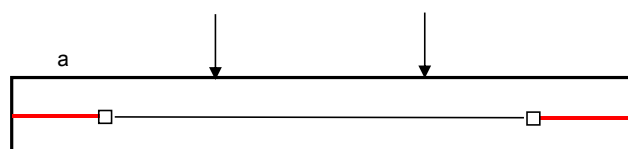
Provete composto para ensaio de flexão, com zona colada a 1/9 do comprimento.
